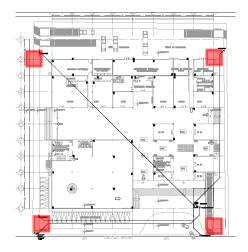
Ubicación en el plano de tomas siamesas en el exterior del conjunto.
